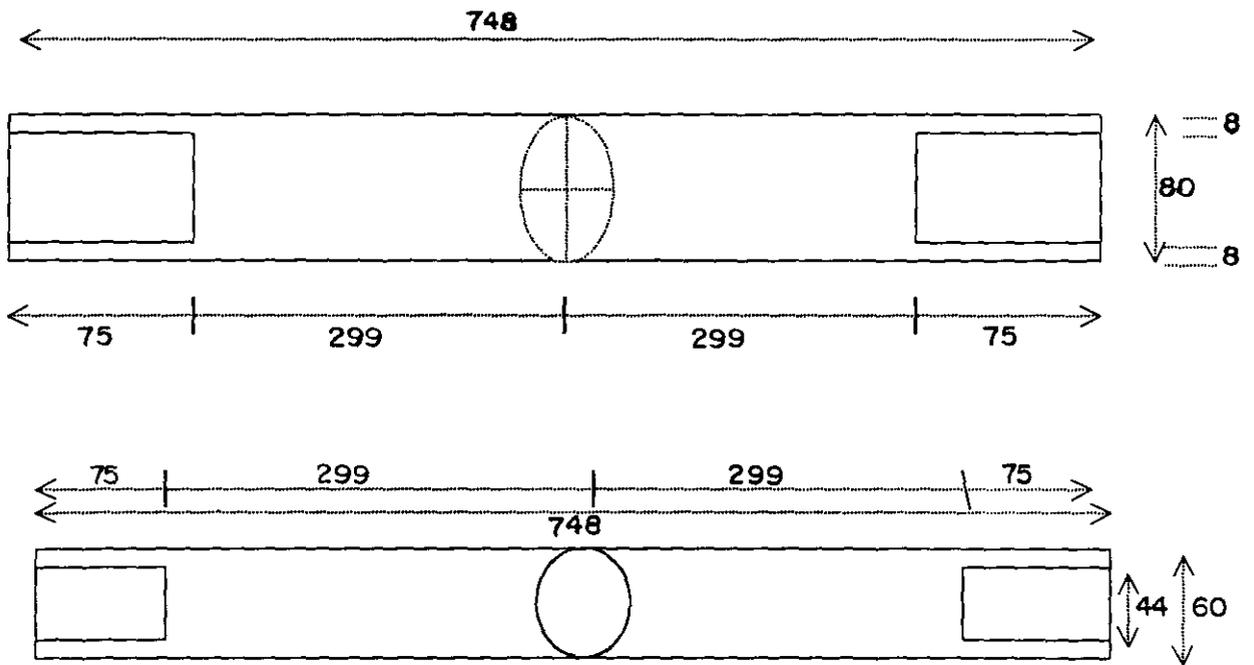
FIG. GEOMÉTRICA DE COLUMNAS PLANTA BAJA Y PRIMER NIVEL.
